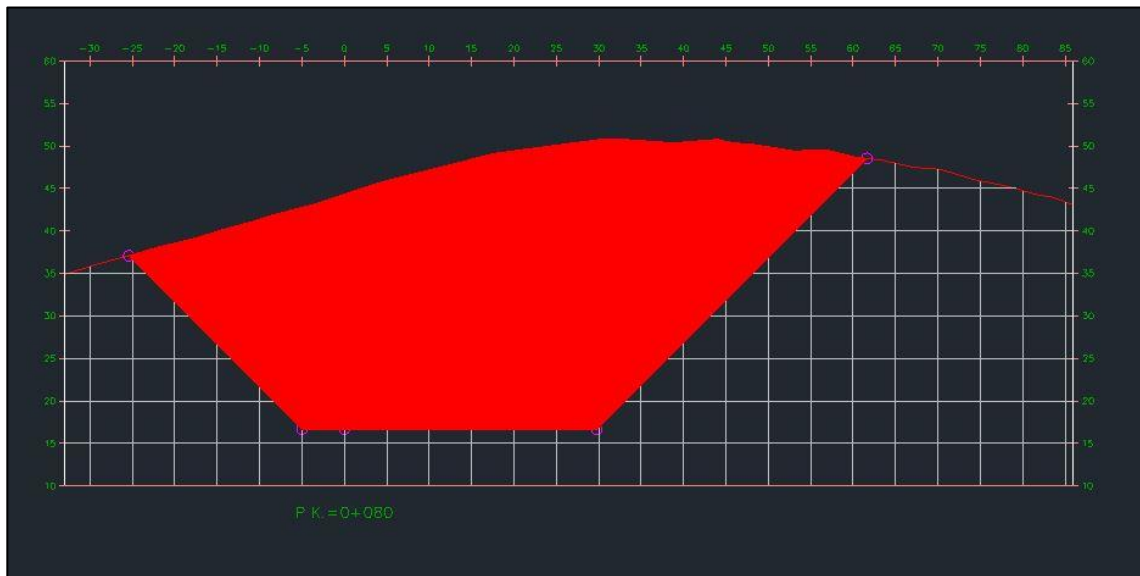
Sección transversal en la que se muestra la excavación necesaria.
